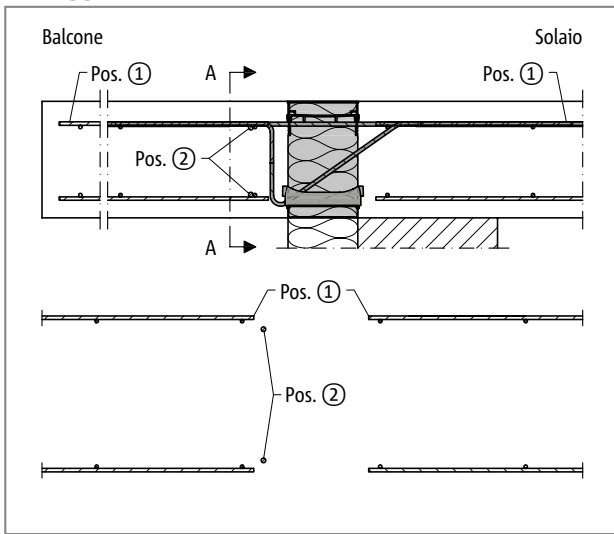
Schöck Isokorb® tipo KXT: armatura in opera con appoggio diretto
